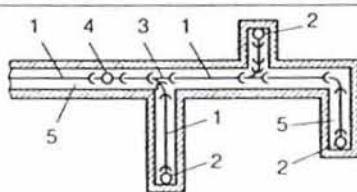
Montarea conductei colectoare în canal sub pardoseală: 1 - conductă colectoare; 2 - coloană; 3 - ramificație la 45°; 4 - piesă de curățire; 5 - canal din beton.
